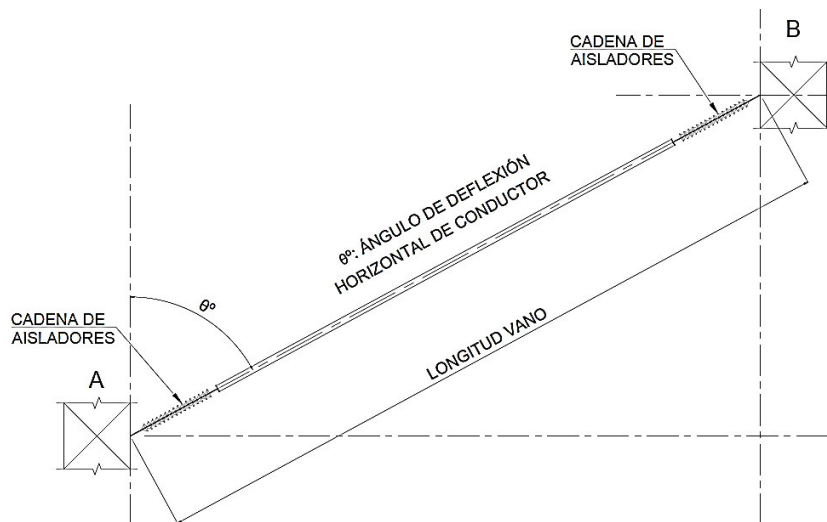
Esquema de conexionado entre estructuras de pórticos – Vista en planta
